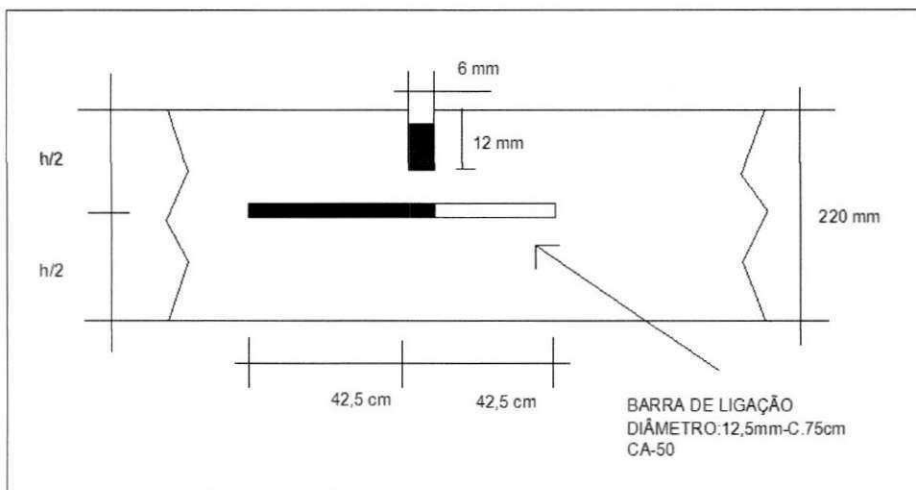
Detalhamento das juntas longitudinais com barras de ligação.
